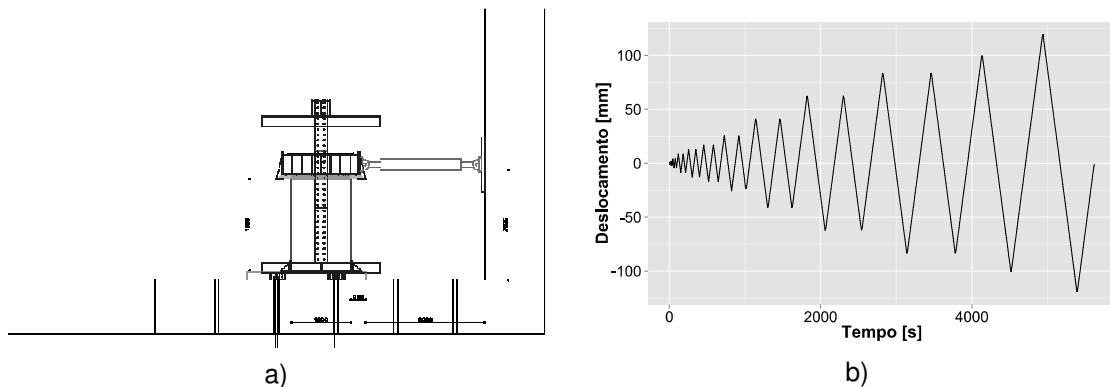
Ensaio com sollicitação biaxial no plano: a) vista lateral do sistema de ensaio; b) procedimento de aplicação de carga horizontal.
